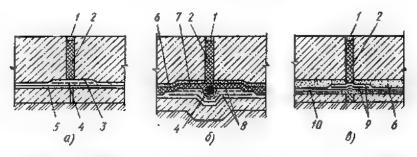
Гидроизоляция деформационных швов на фундаментных плитах или полуподвала (a в);
